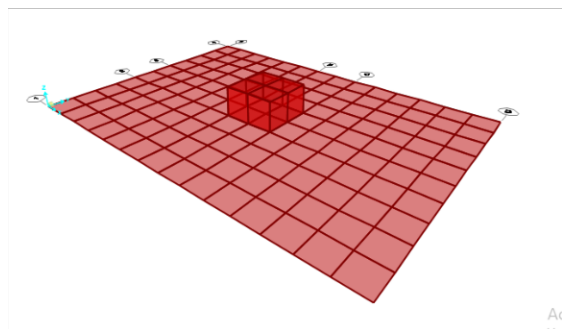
de MEF: modelo completo de zapata, con el mallado tanto en columna y losa de cimentación.
